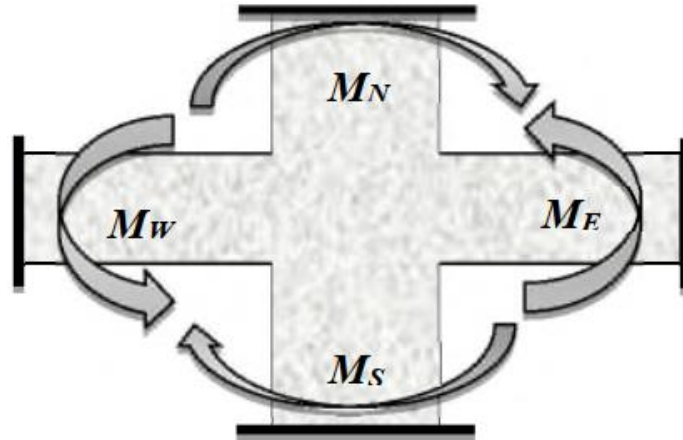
Dimensionnement d'un nœud poutre-poteau.
